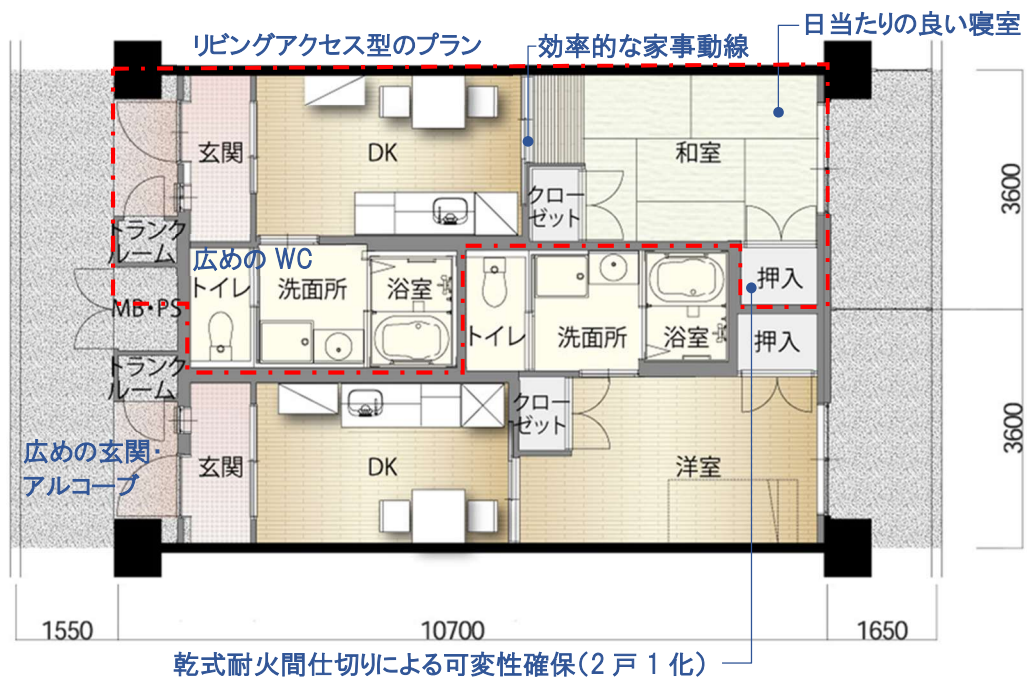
1DK_PLAN 約35㎡（1人世帯用）
